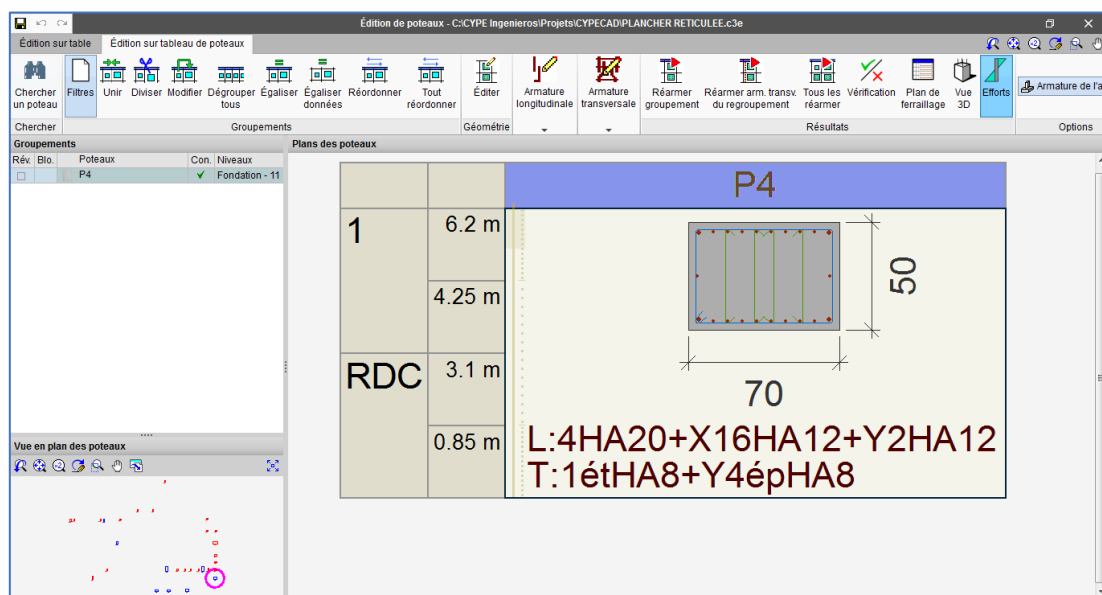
Ferrailage du poteau Pg4 sur CYPECAD, modèle du plancher réticulé
